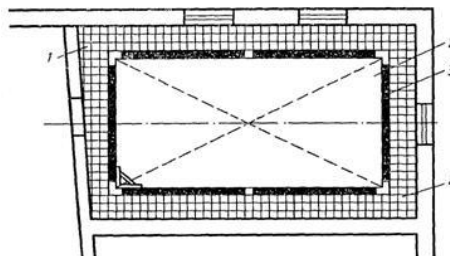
Разбивка непрямоугольного покрытия пола: 1 - участок с прирубленными плитками, 2 - фон пола, 3 - фриз, 4 – заделка
